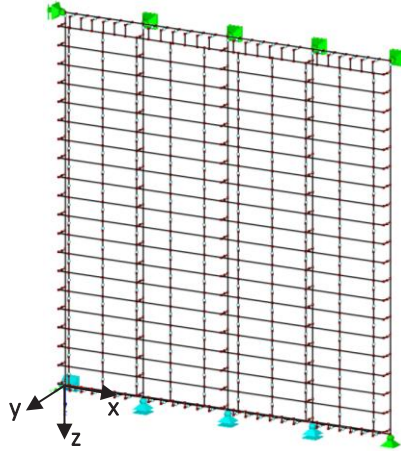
Statisches System der Stabwerksmodelle für die Deckenelemente
